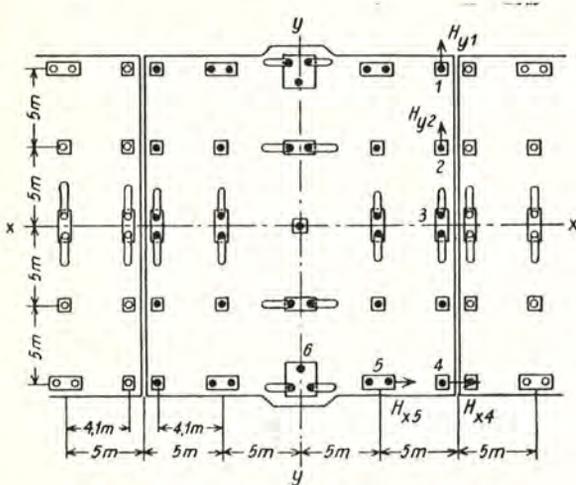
Plans de la fondation sur pieux d'une section du bâtiment.
